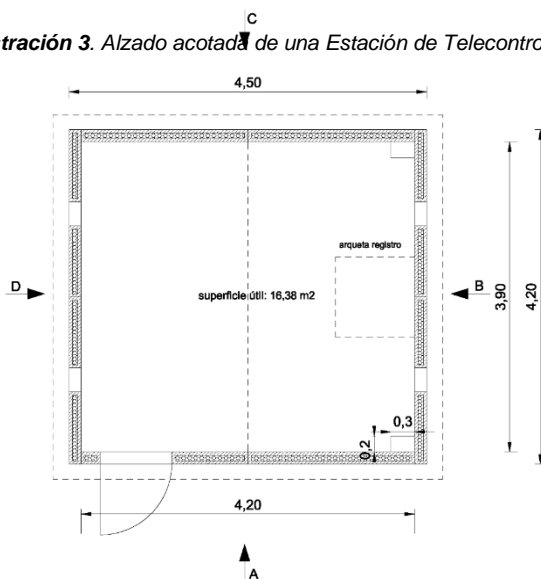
Planta acotada de una Estación de Telecontrol Tipo
